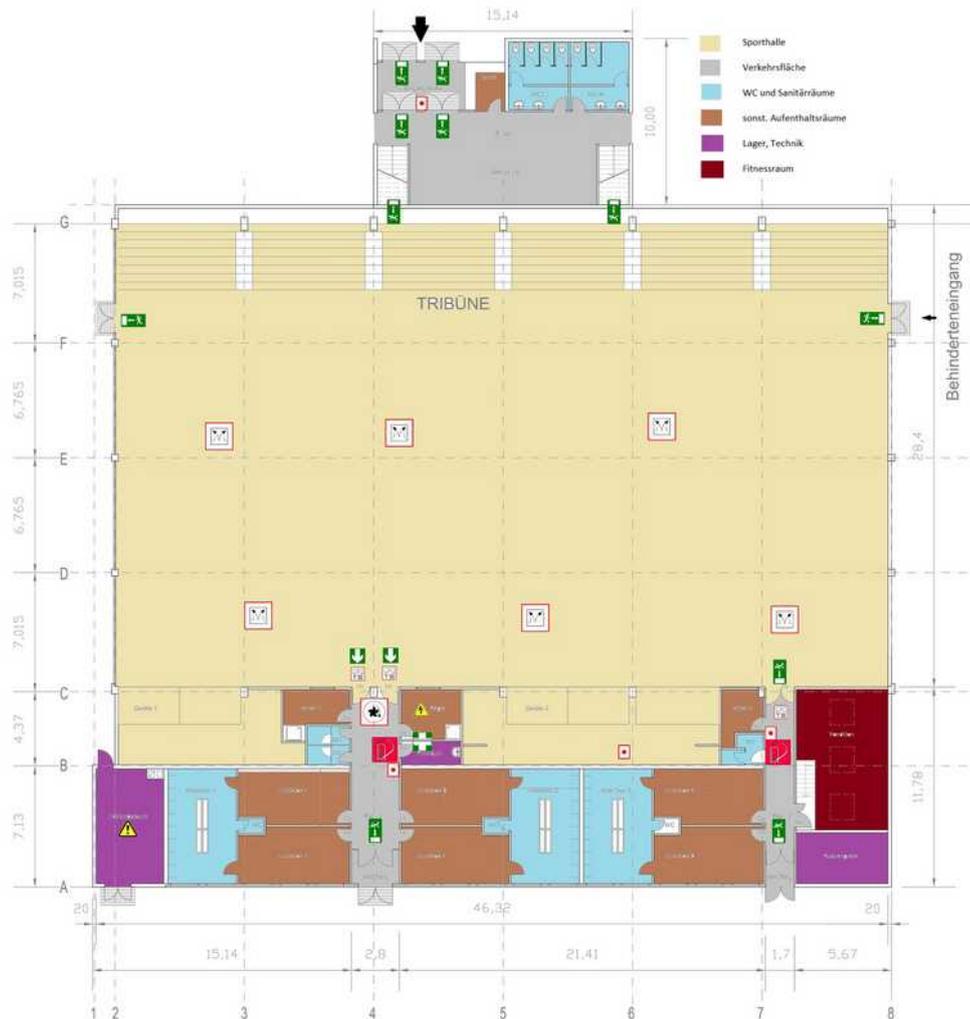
Grundriss mit Nutzungszonen
